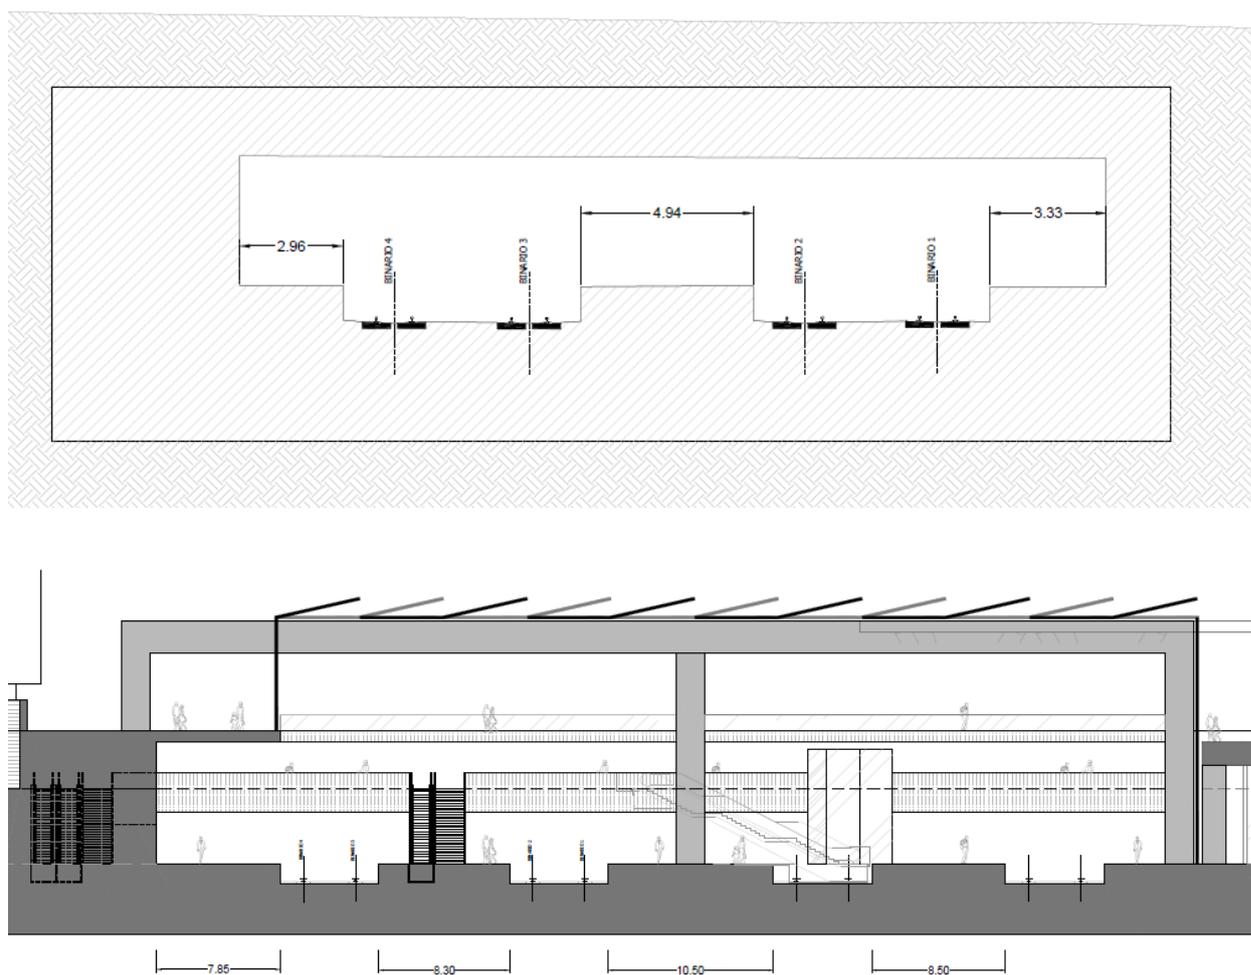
Stazione Piazza Garibaldi (ante e post operam)
